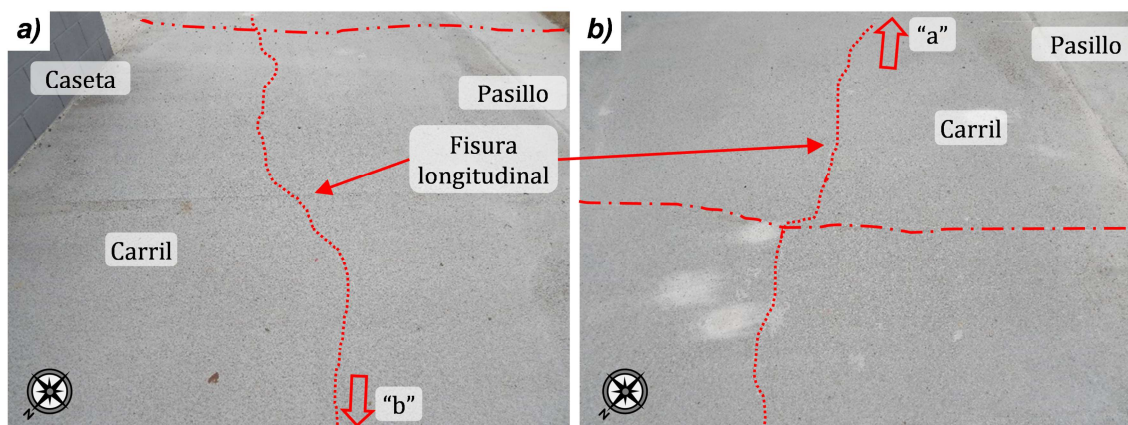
90 – Fisuras aparecidas en el carril
